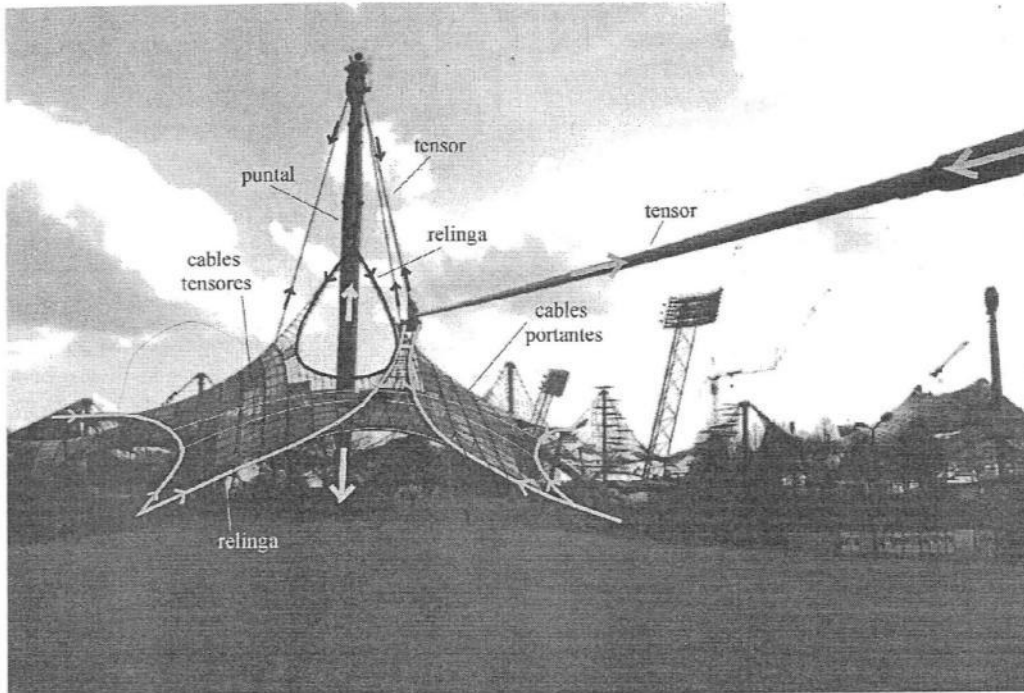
e: Detalle de los componentes estructurales de las cubiertas.
